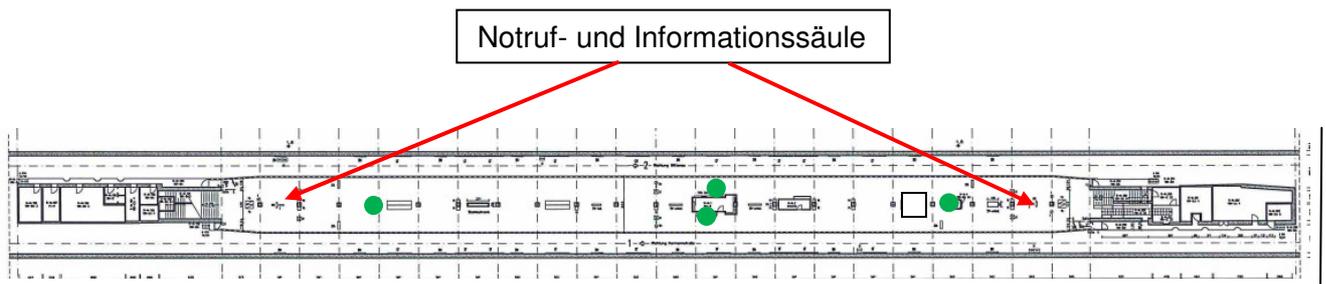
Ausschnitt aus dem Grundriss des Bahnsteigs mit Kennzeichnung der Lage der Notruf- und Informationssäulen sowie der Notsignalschalter (●)
